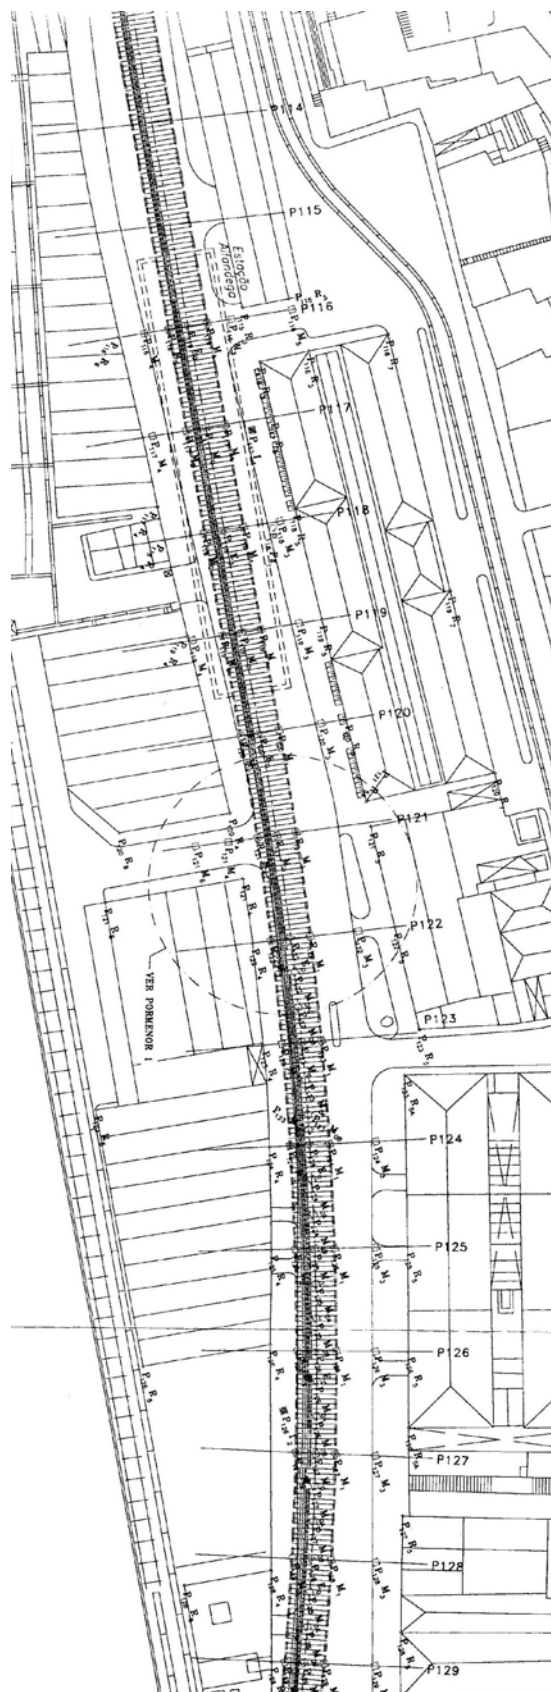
Planta de localização da instrumentação do troço 65 – Terreiro do Paço – Santa Apolónia. Secções P114 a P129.
